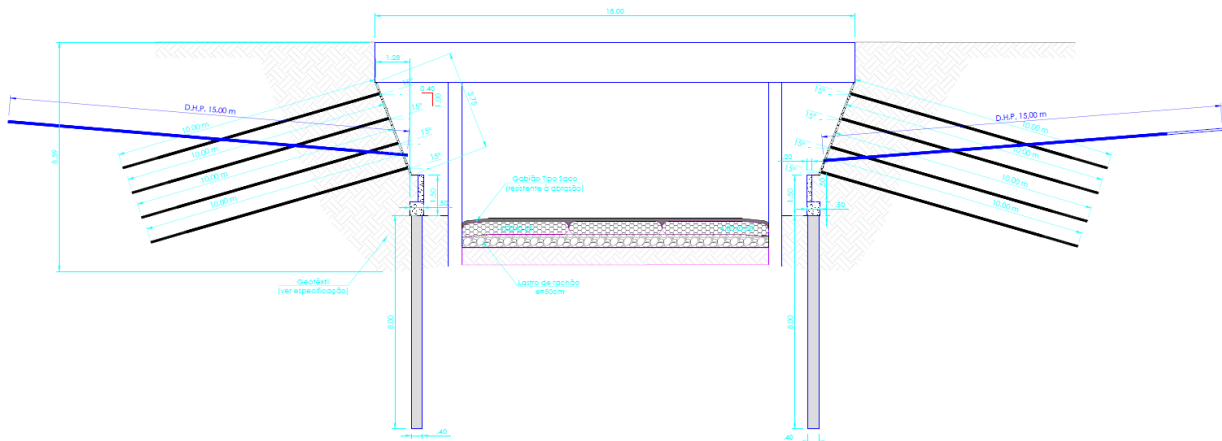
Seção transversal da cortina de contenção com drenos horizontais.
